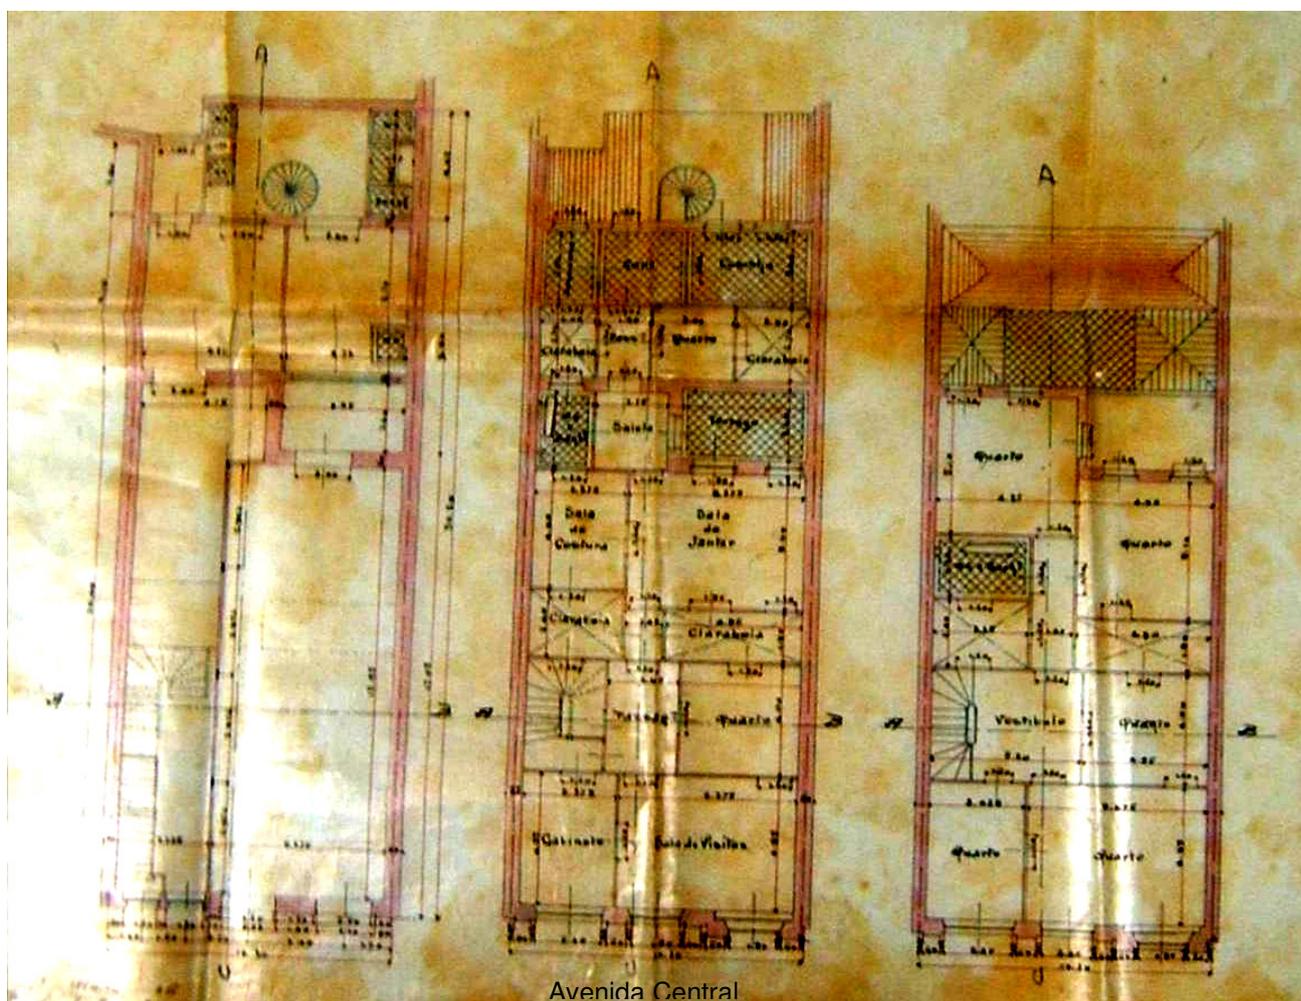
Plantas baixas do prédio nº181, referente ao bloco frontal, voltado para a Avenida Central. Projeto de René Barba (Arquivo Nacional, fotografia da autora).
